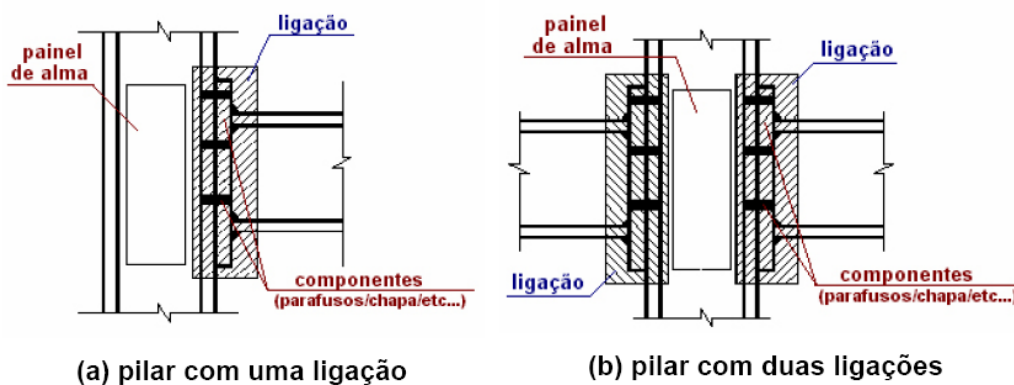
Ligação viga-pilar com chapa de topo (MAGGI, 2004)
